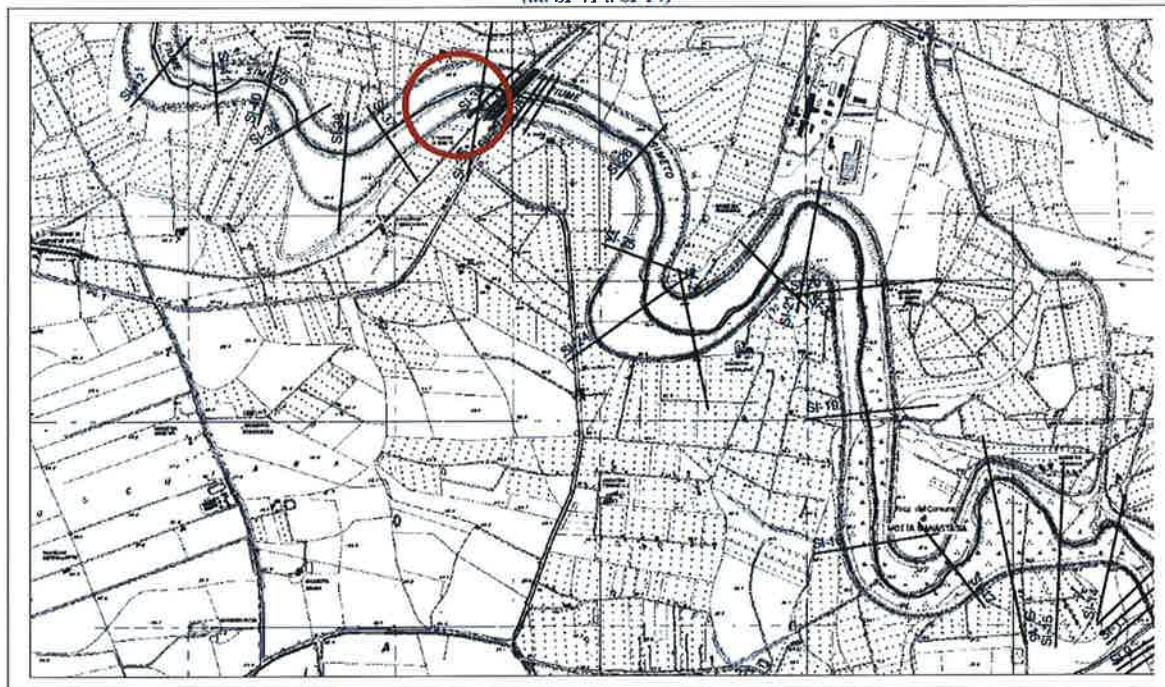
Stralcio planimetrico con indicazione delle sezioni idrauliche in prossimità del viadotto di progetto.
